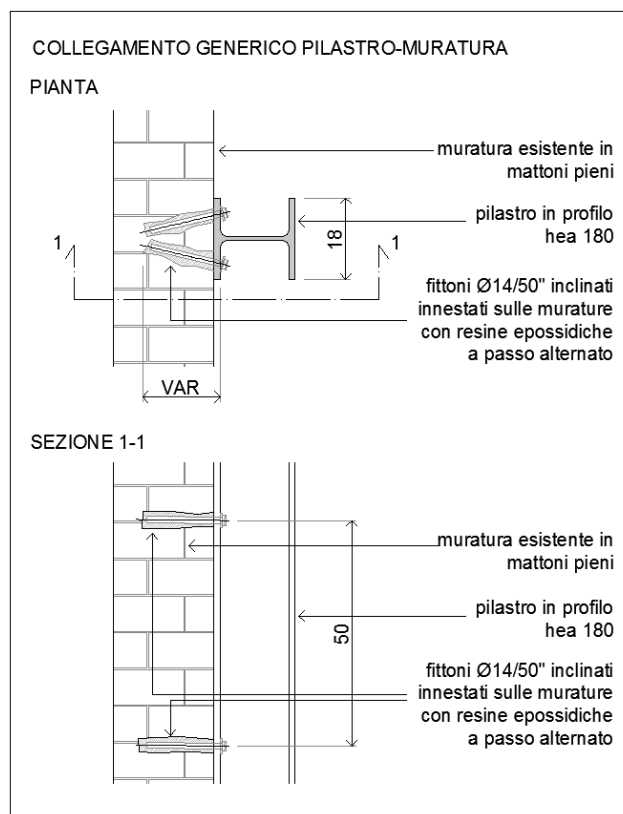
Particolare fissaggio tra pilastri in acciaio e muratura
